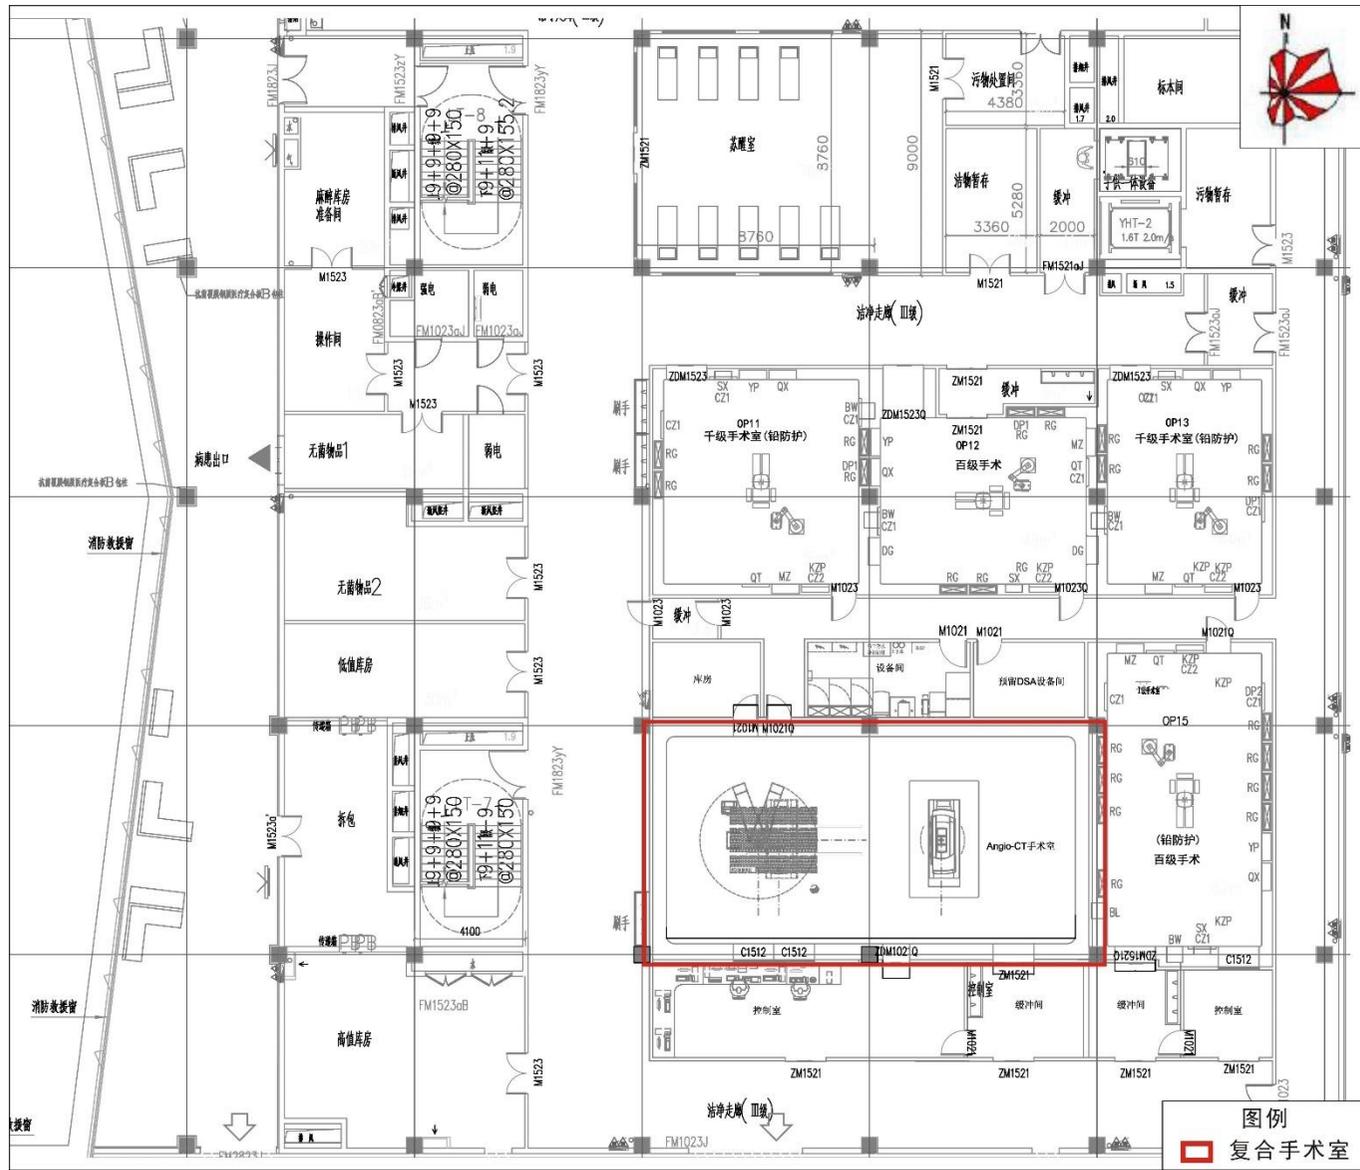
医技楼一楼平面布局示意图 (医技楼中部)
